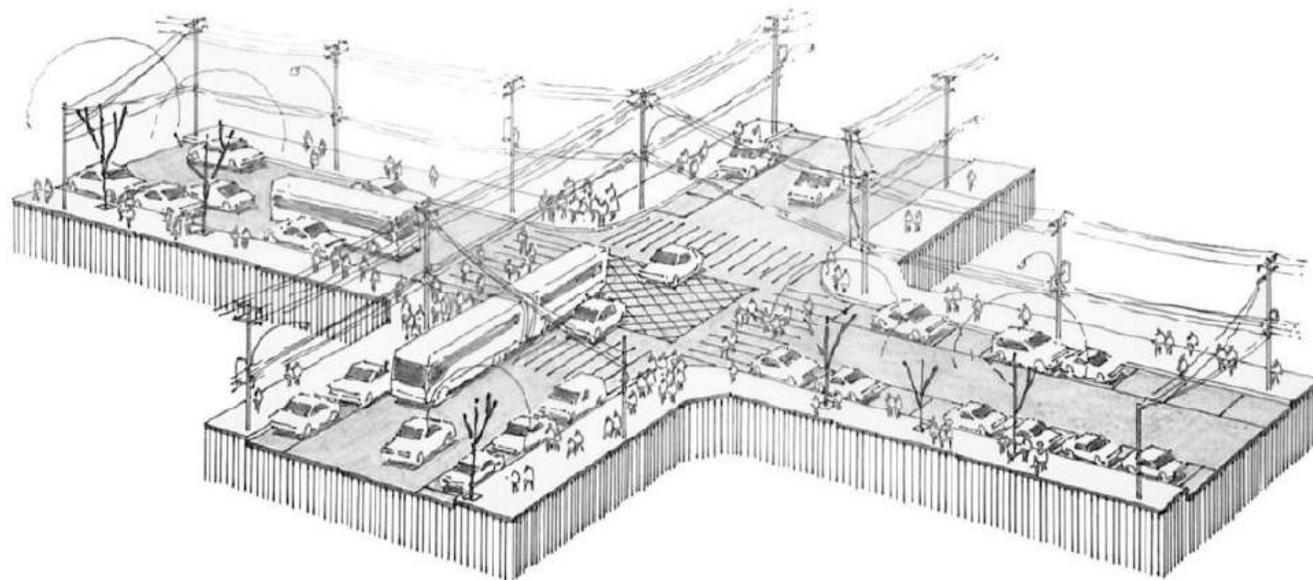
Corte Tipo da Rua Pedro de Toledo. ELABORAÇÃO: MPS, 2018.
